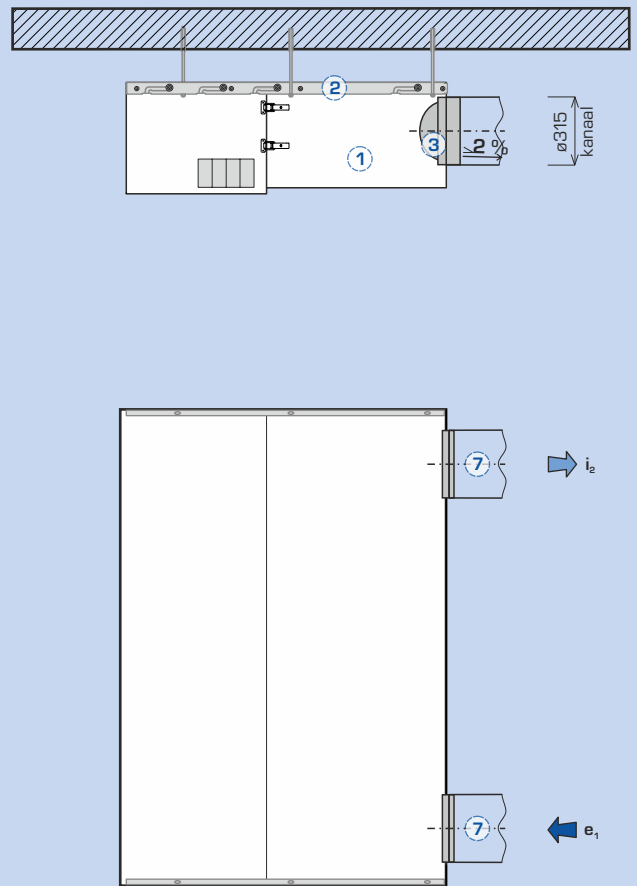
## DETAILS VAN INSTALLATIE EN GEVELDOORVOER
